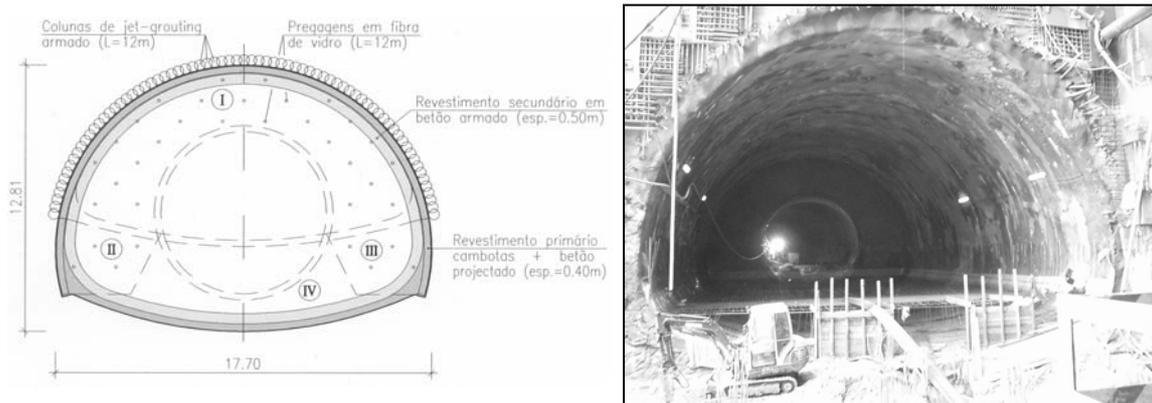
Secção transversal tipo, faseamento executivo e vista a partir do poço do Túnel 4 nascente na fase final de instalação do revestimento primário
